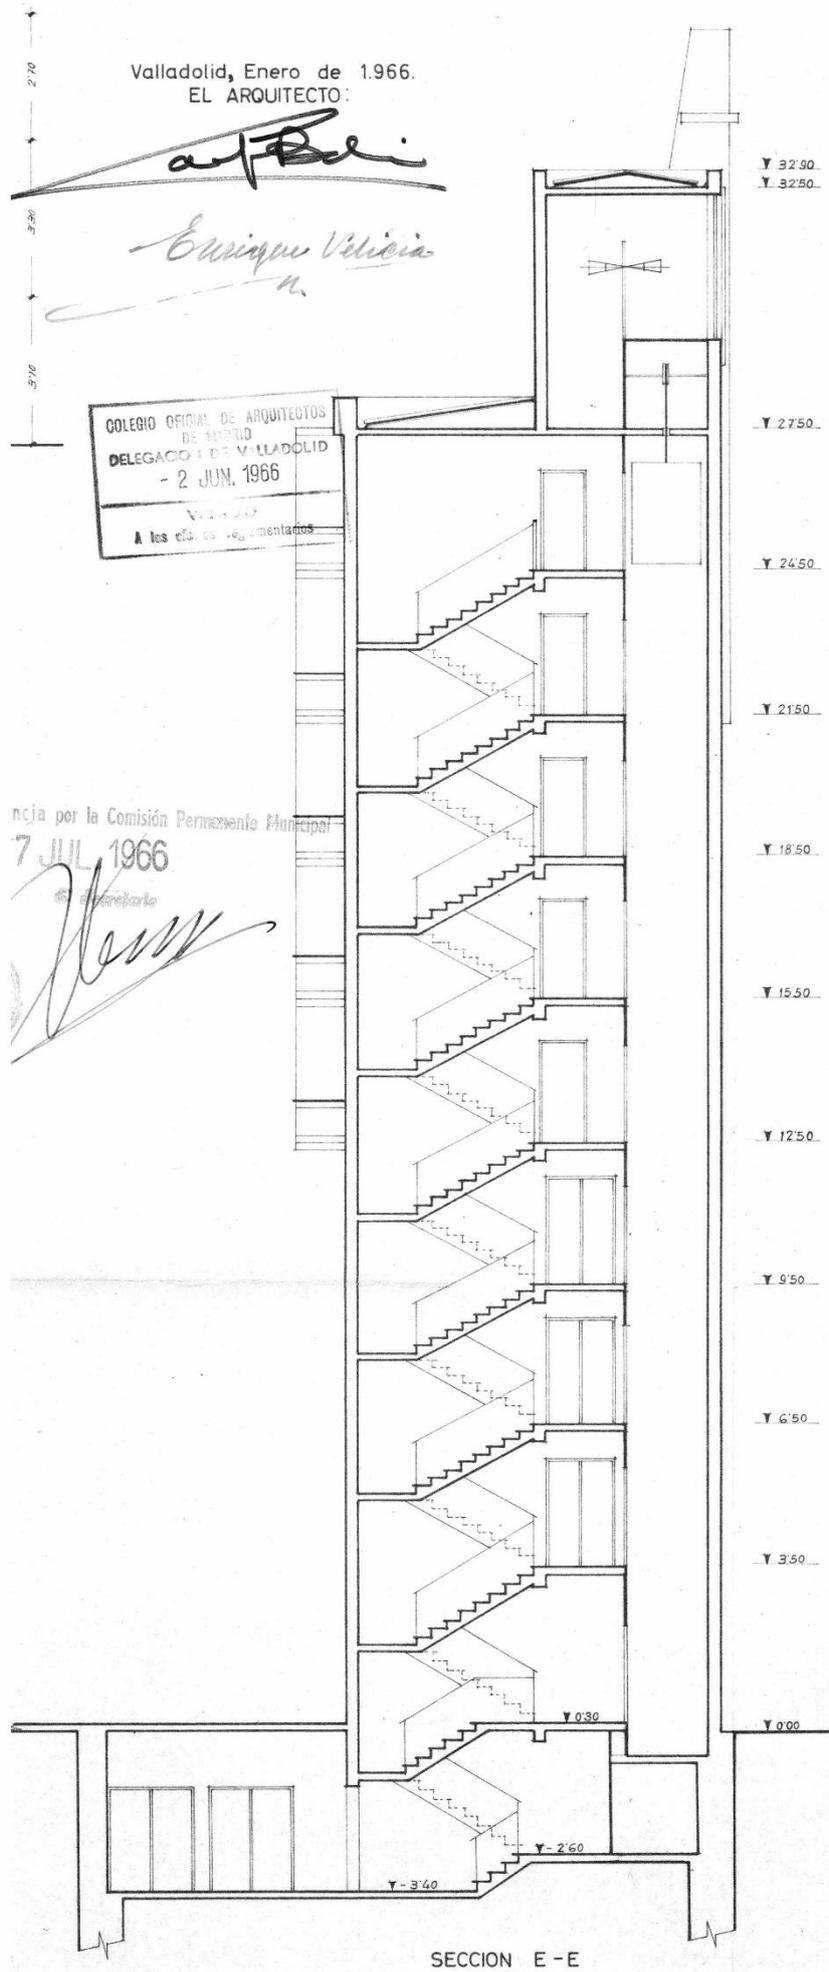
Sección perpendicular al eje de la calle. Fuente: Plano de proyecto original. Archivo Municipal de Valladolid. (Levantamiento interior no efectuado)
